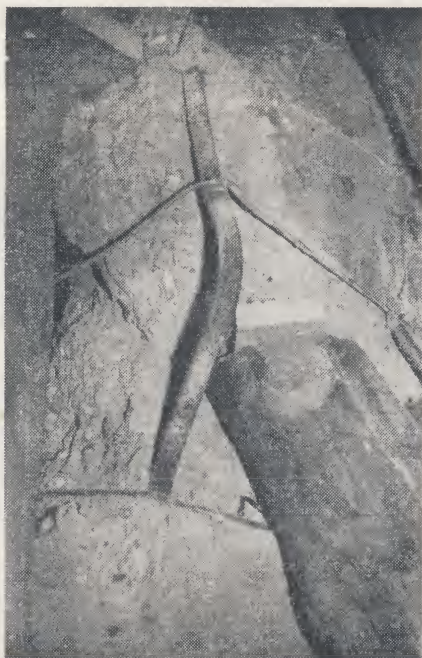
Izbacivanje armature u stupu armiranobetonskog skeleta
